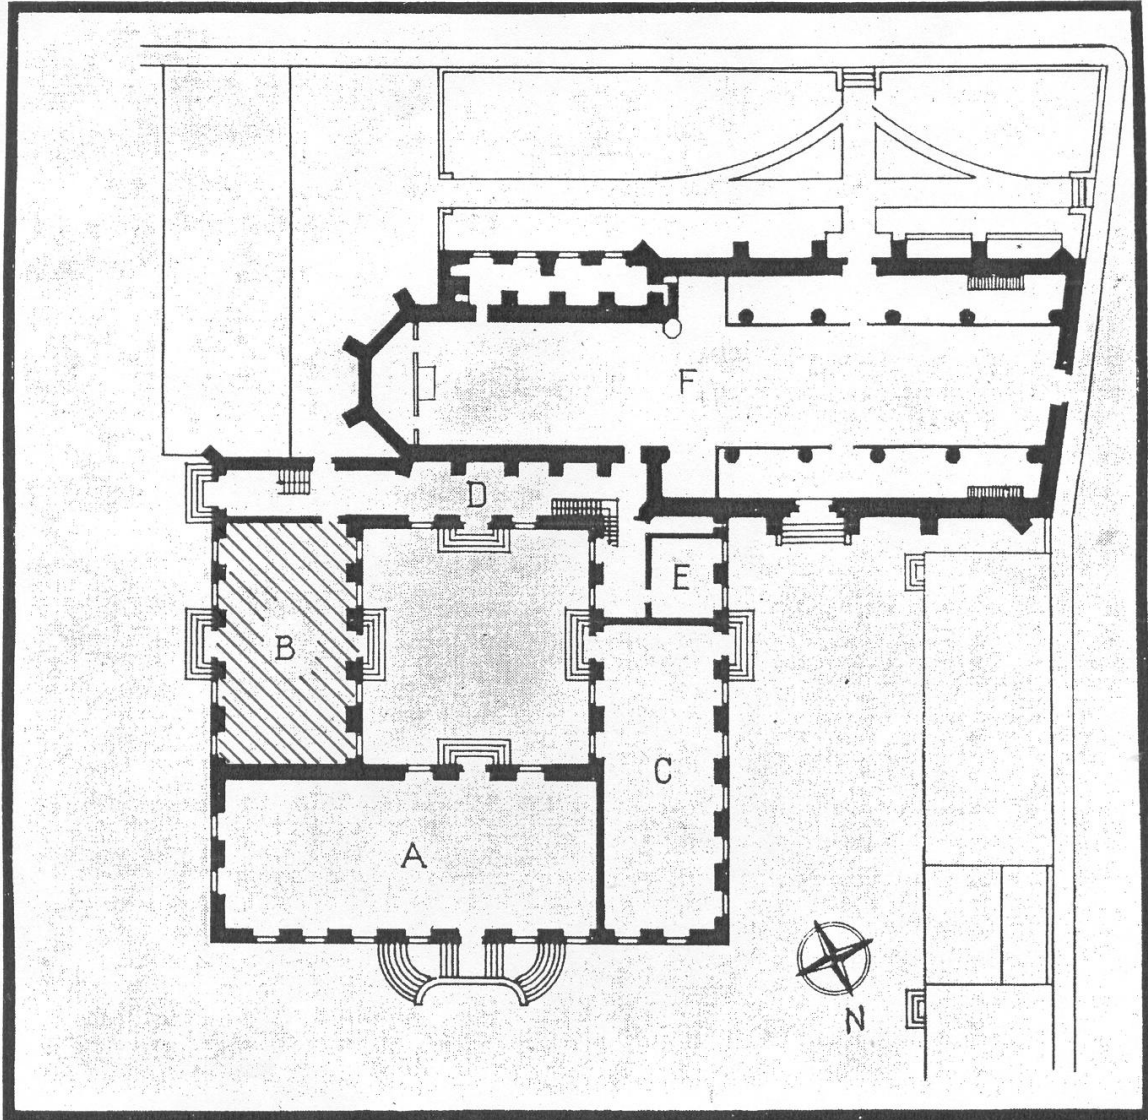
Erdgeschoß des Kollegienhauses im Jahre 1748
